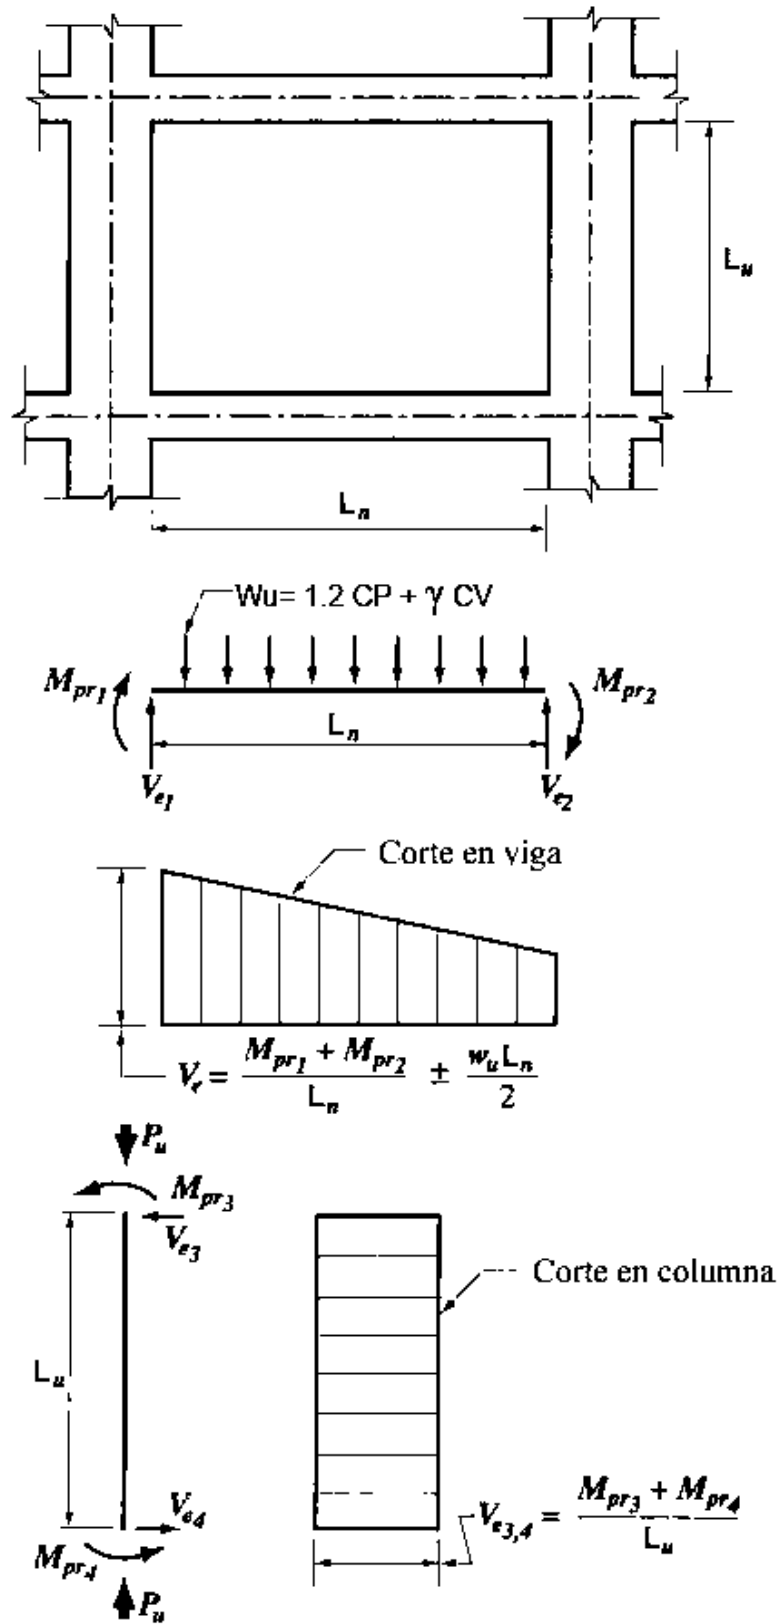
Diseño por corte para vigas y columnas con nivel de diseño ND3
